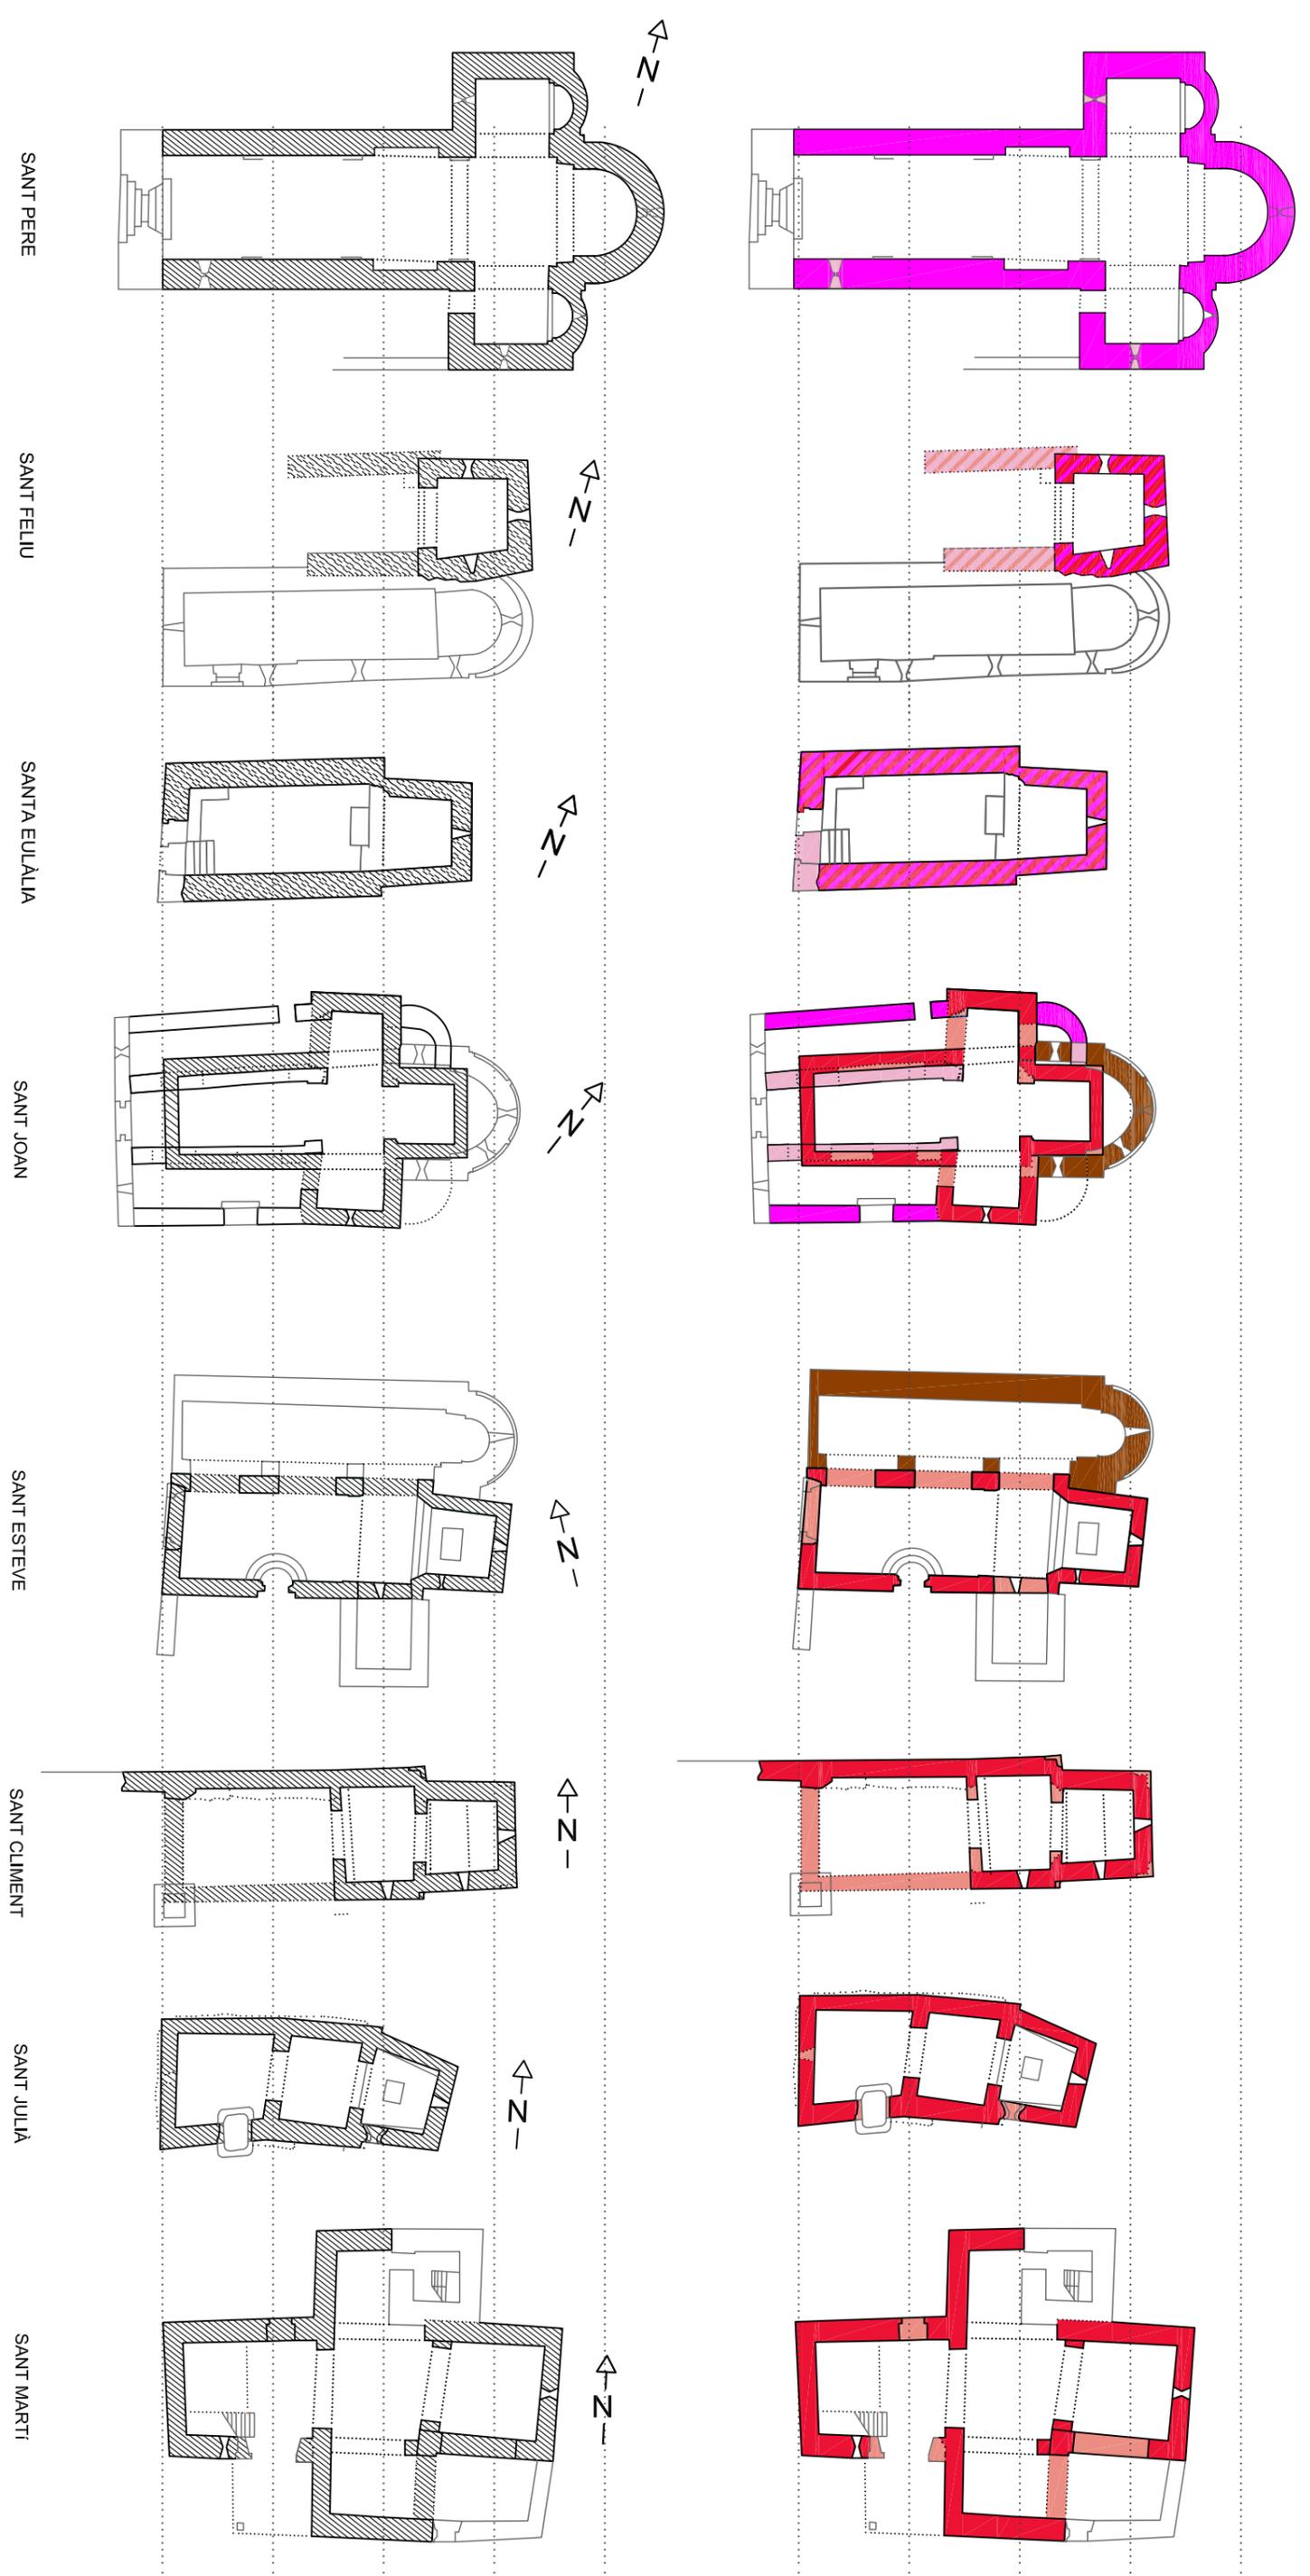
Conjunto de las iglesias analizadas para el siglo IX. Plantas crono-cromáticas. Planimetría de la autora.
